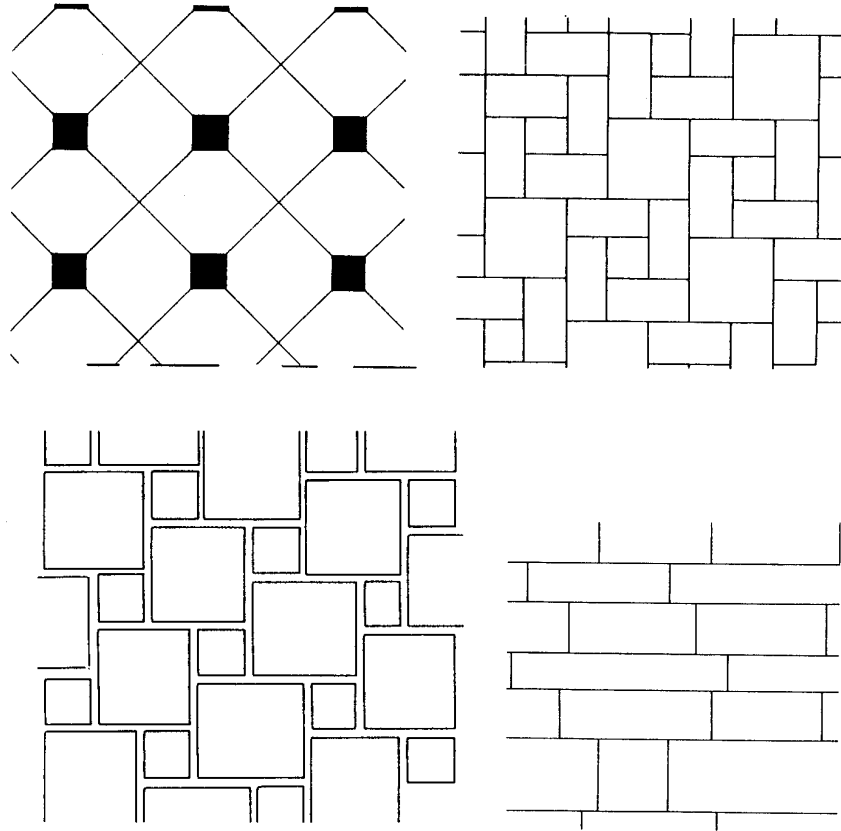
Distintos tipos de diseños de pavimentos.
